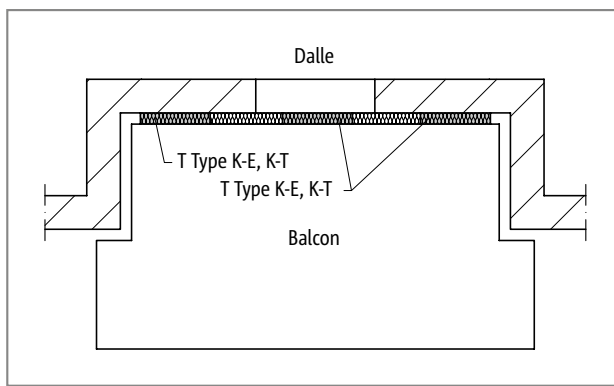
Schöck Isokorb® T Type K-E, K-T : Balcon avec retrait de façade
